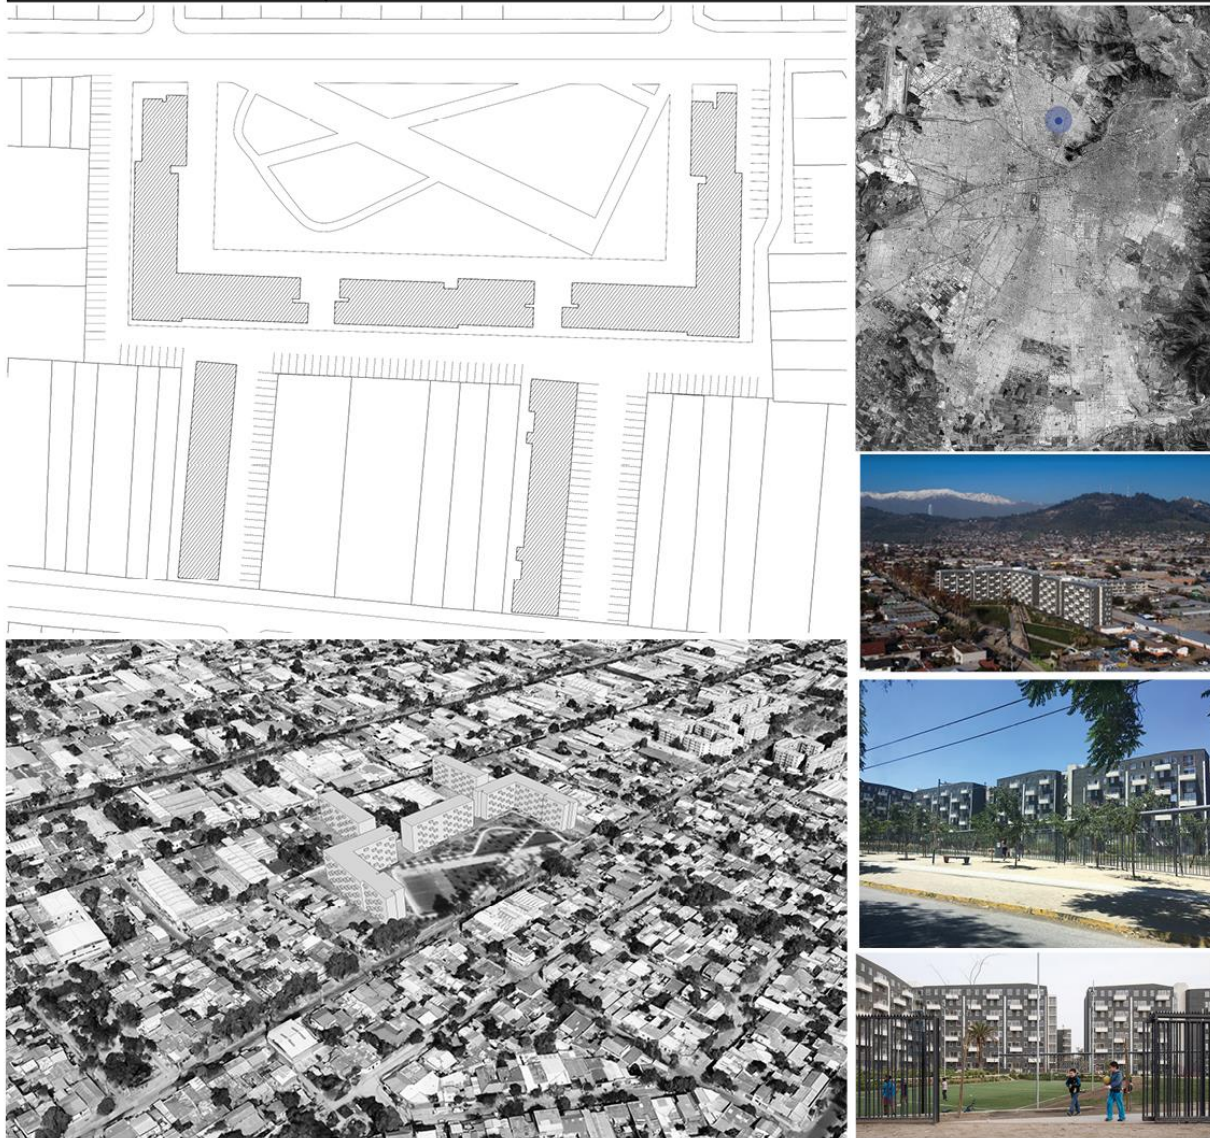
ficha Conjunto Habitacional Gabriel Palma. / Planta conjunto, plano ubicación y vista aérea: elaboración propia. / Imágenes 1 y 3: Premio Aporte Urbano 2017. Imagen 3: Archivo de la autora (2019)
